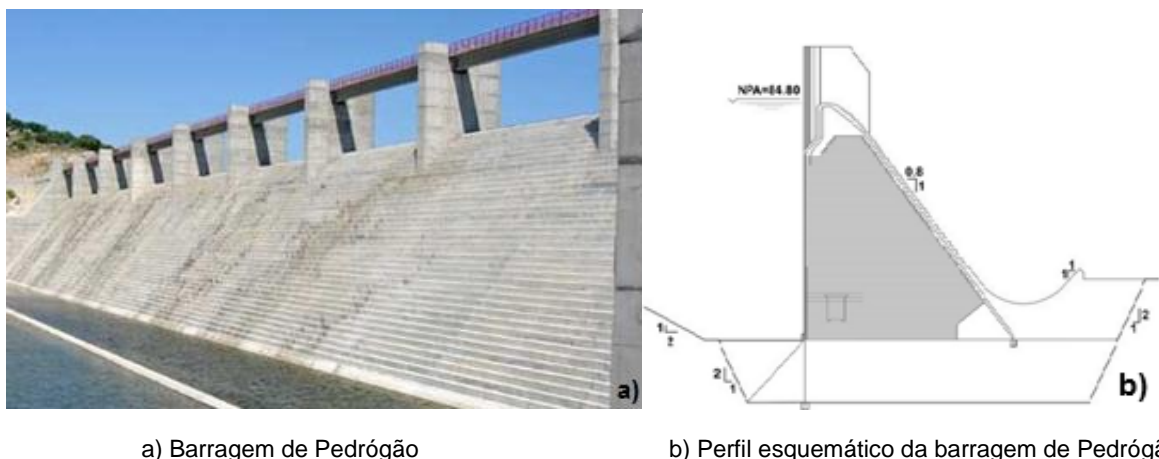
Barragem de betão compactado com cilindro (BCC) - (cnpqb.apambiente.pt)
